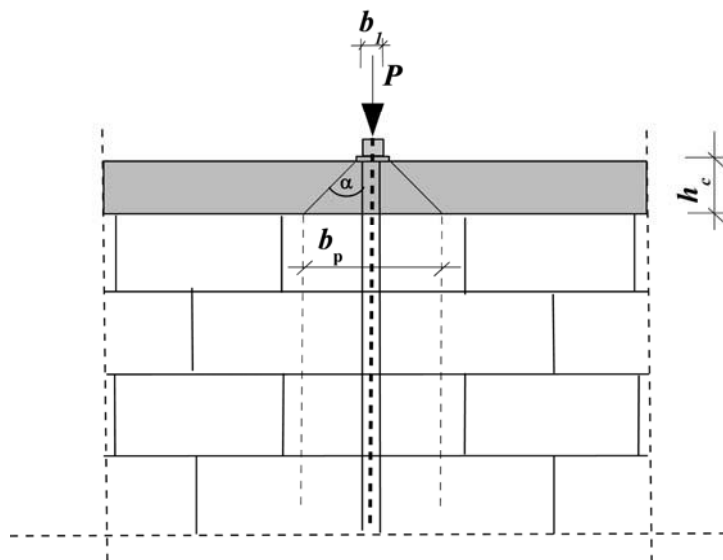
Teilflächenbelastung und Lastausbreitung im Mauerwerk infolge Spannkrafteinleitung
